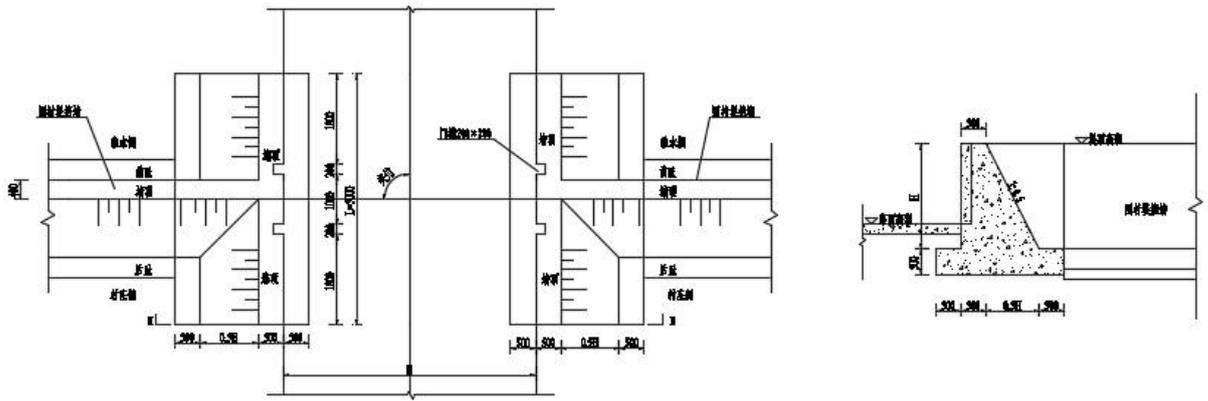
围村堤 A 型路口闸挡墙立面及断面图
